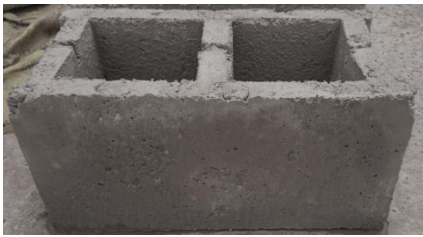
Vaciado y Vibrado – Bloques de Hormigón con FB
